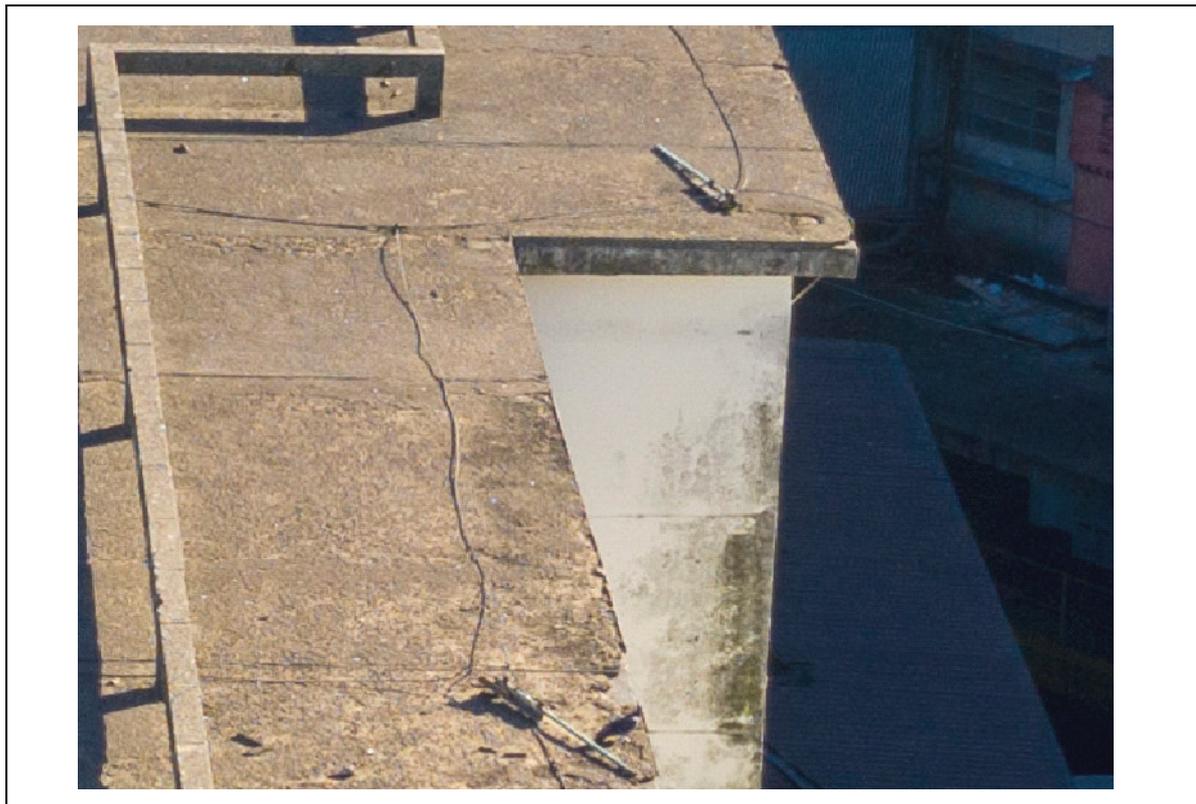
DETALHE DA FOTO ANTERIOR: ALGUMAS HASTES DO SPDA ESTÃO SEM FIXAÇÃO NA POSIÇÃO VERTICAL.
